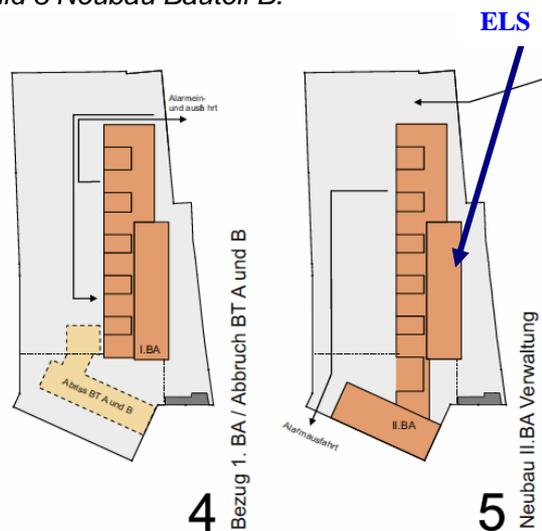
Probetrieb ELS, Inbetriebnahme, Umzug Einsatzdienst, Abriss Bauteil A Bild 5 Fertigstellung der FW 1
